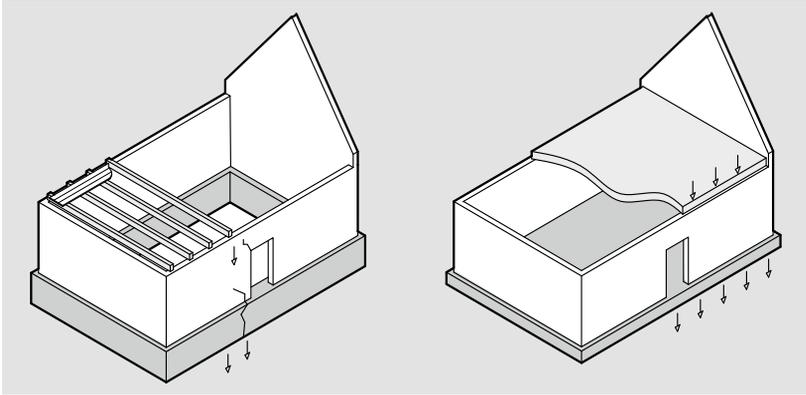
Schematischer Konstruktionsvergleich: Haus um 1900 (links) und Haus in moderner Bauweise (rechts)
